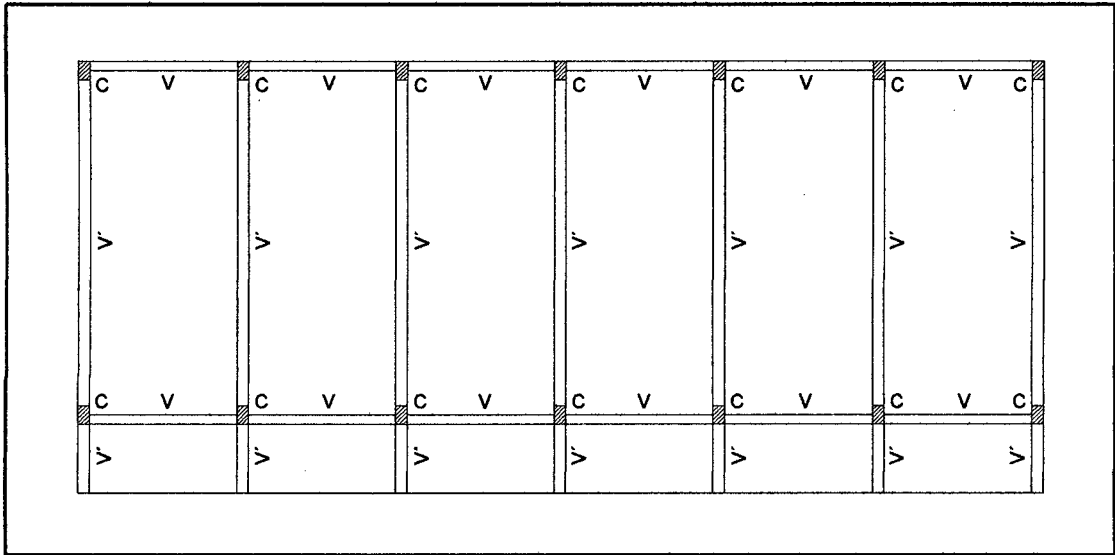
Configuración en planta de los elementos resistentes del pabellón 2.
